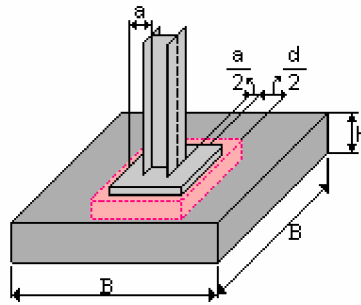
Cortante bidireccional en zapata que soporta columna metálica.
